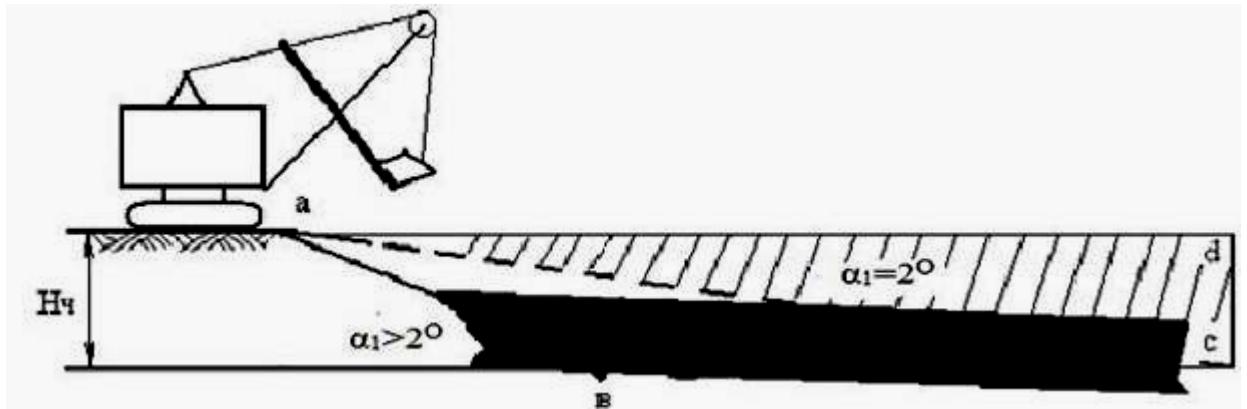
Схема отработки угольного пласта экскаватором-мехлопатою с превышением наклона рабочей площадки
